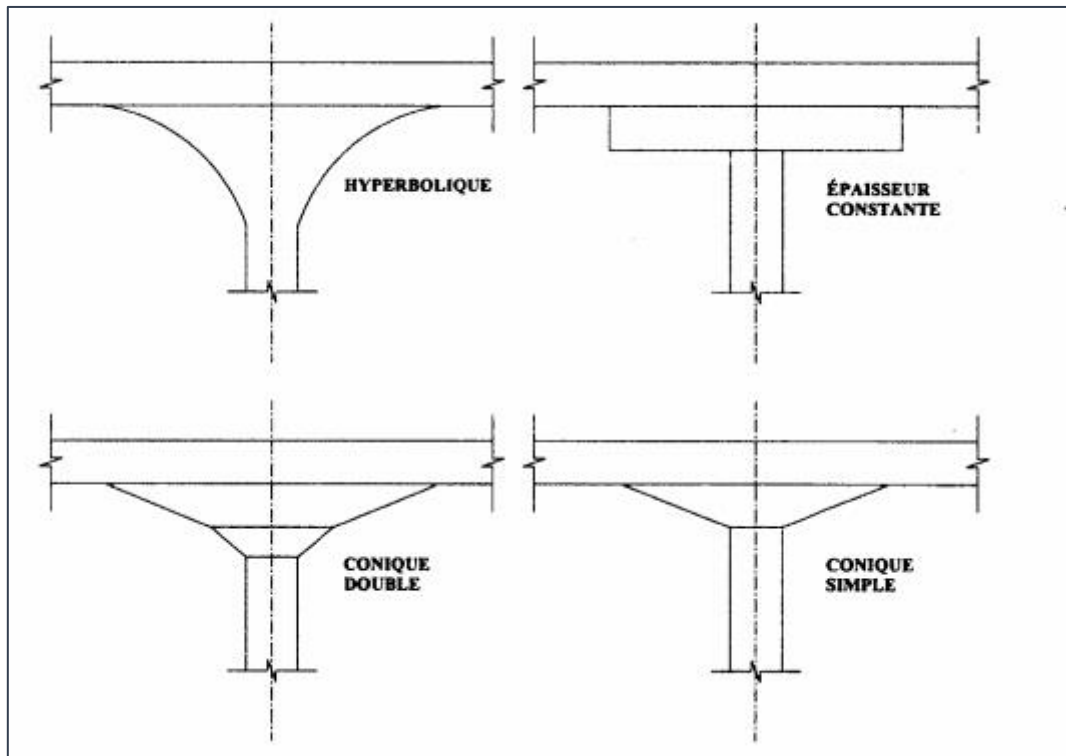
Géométries possibles des ressauts des planchers-dalles face au poinçonnement
